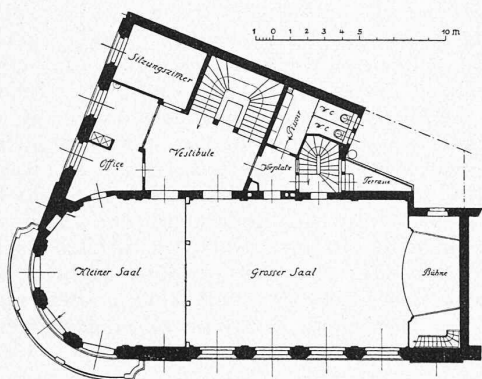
bis 3. Keller, Erdgeschoss und I. Stock. — Grundrisse 1 : 400. — Abb. 4 bis 6. I. Obergeschoss und Dachgeschosse.
